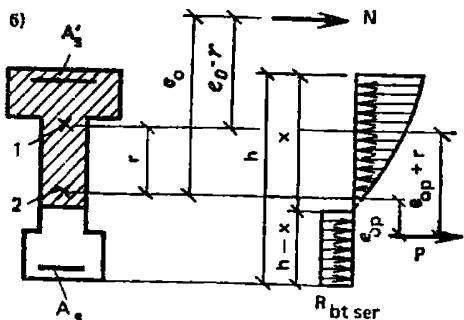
Схема усилий предварительного напряжения в арматуре и сетках в поперечном сечении армоцементного элемента
